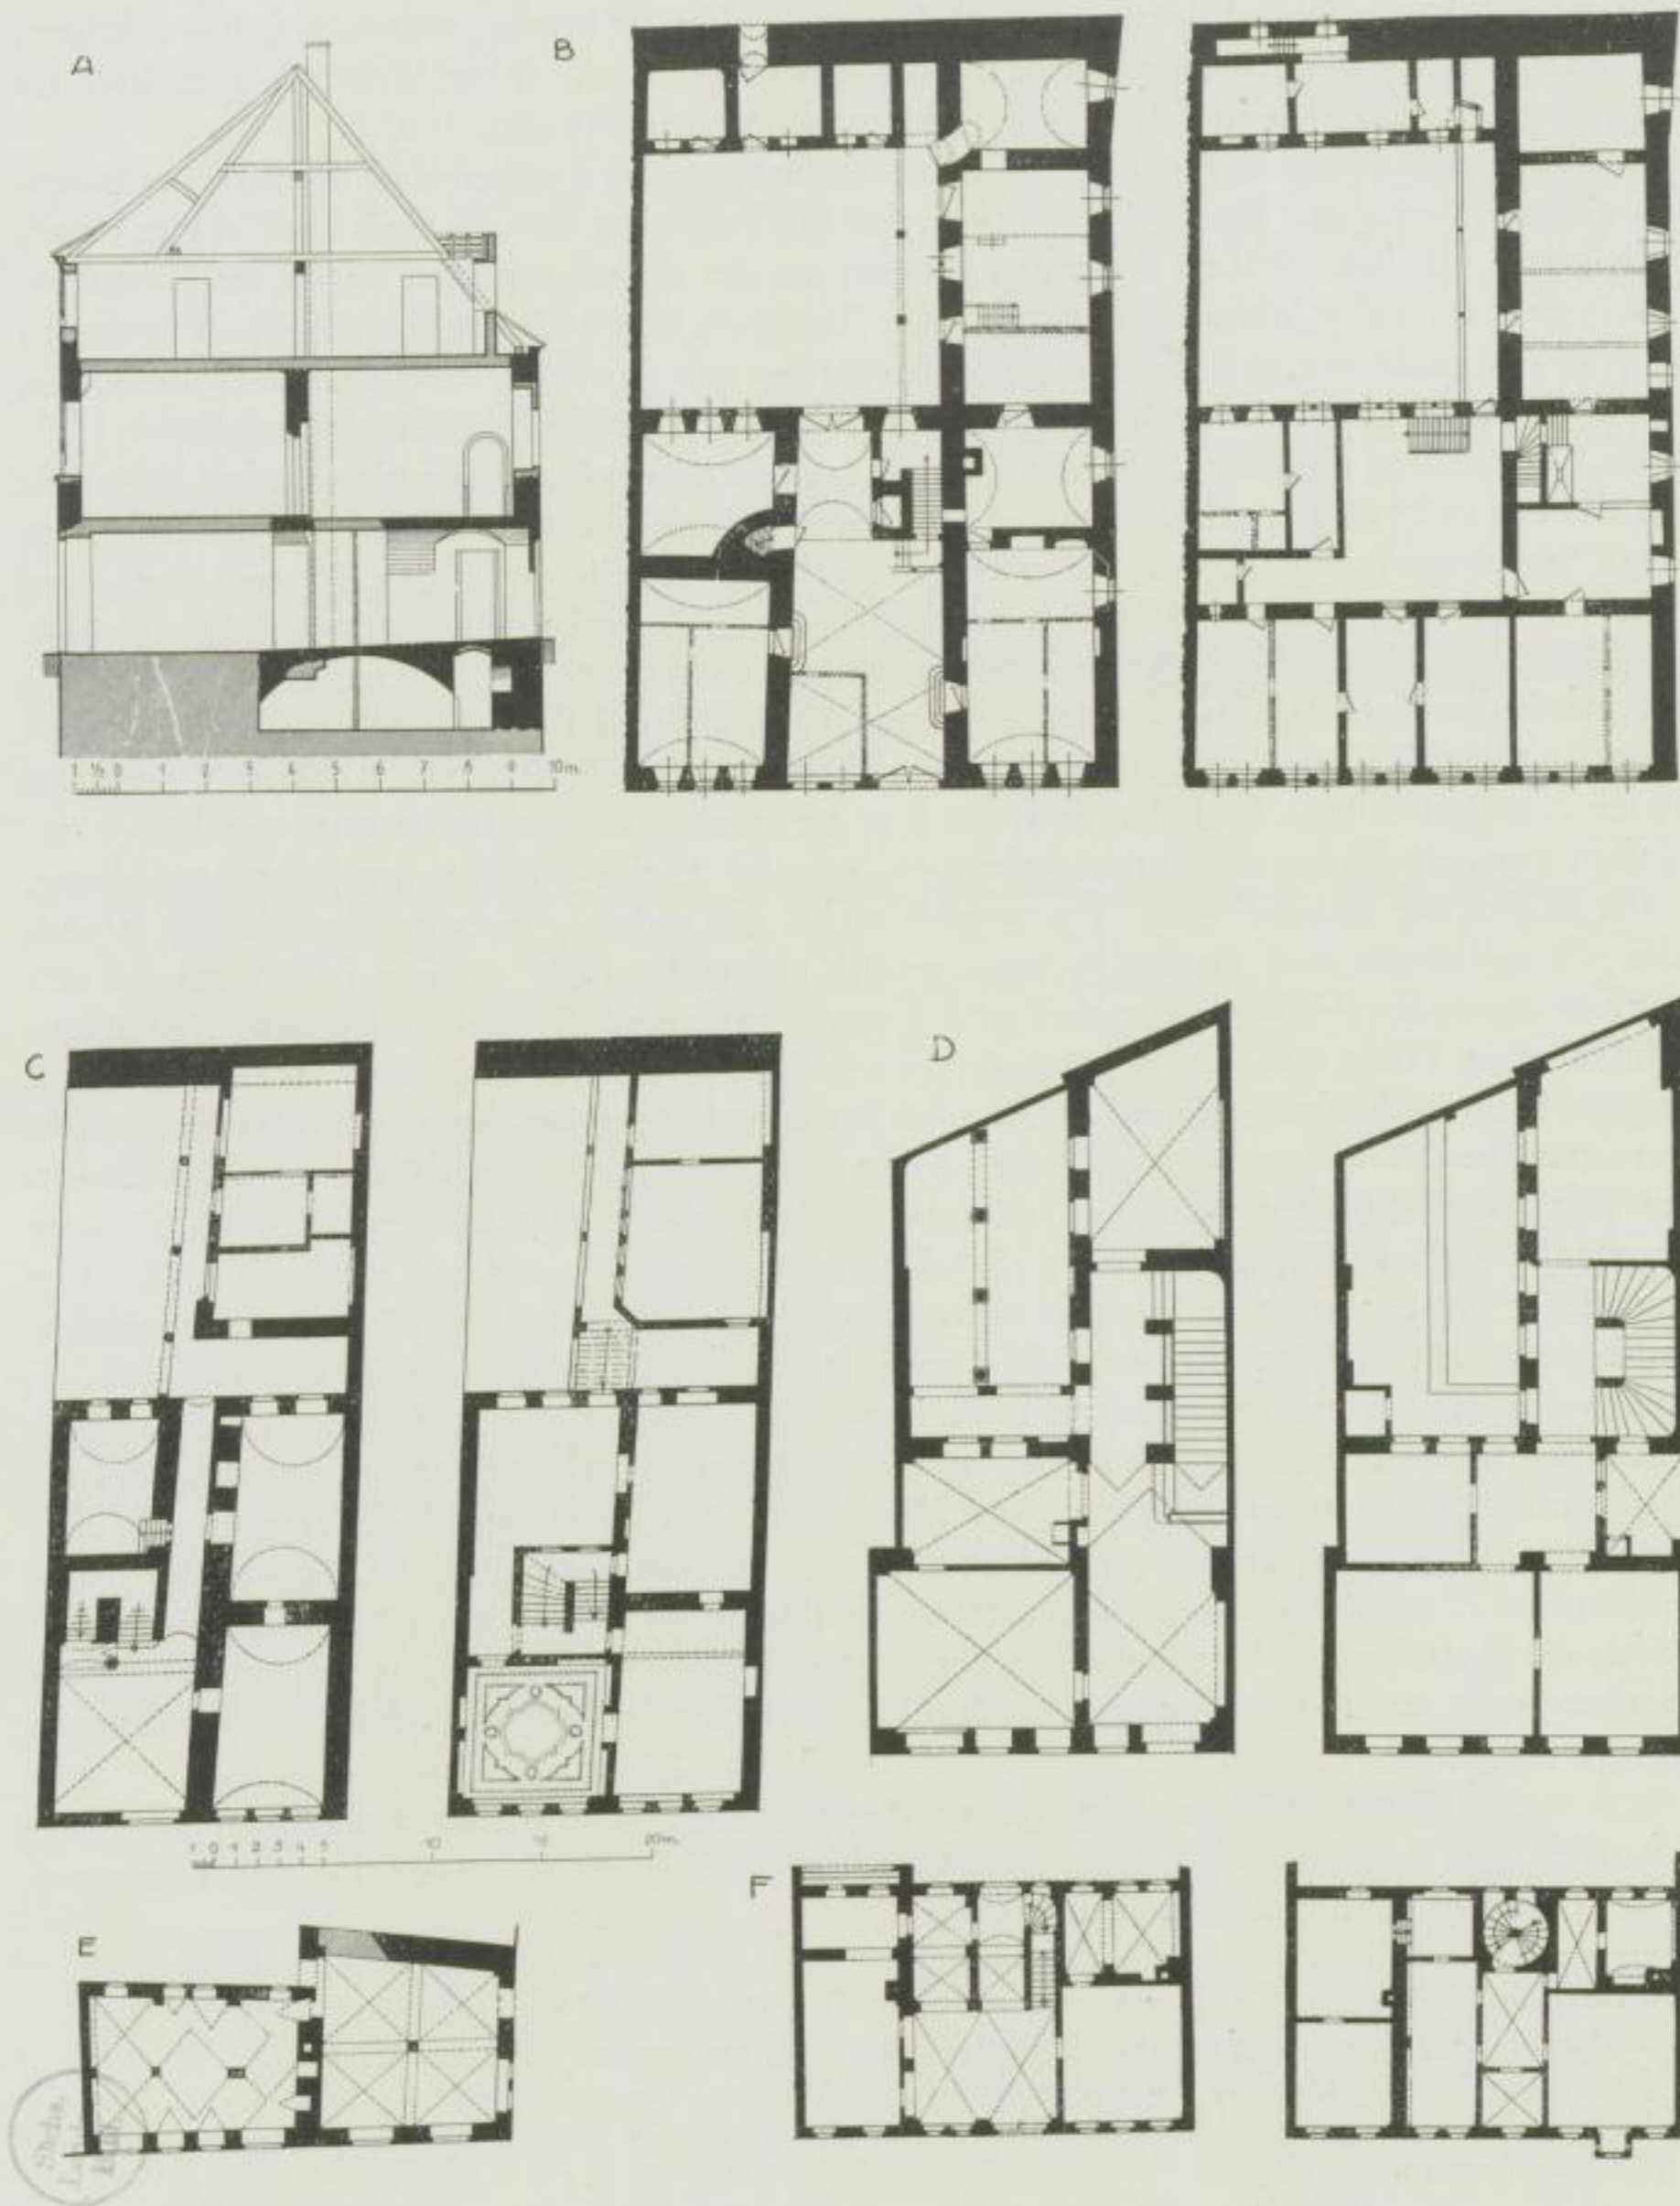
A Schnitt durch ein Klosterhaus. Grundrisse: B Dohnaifche Straße 16; C Dohnaifche Straße 15; D Dohnaifche Straße 26; E Lange Straße 1; F Lange Straße 43
